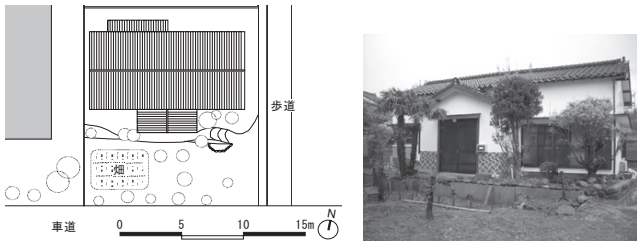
配置図 (事例 16) 写真 10 外観 (事例 16)
